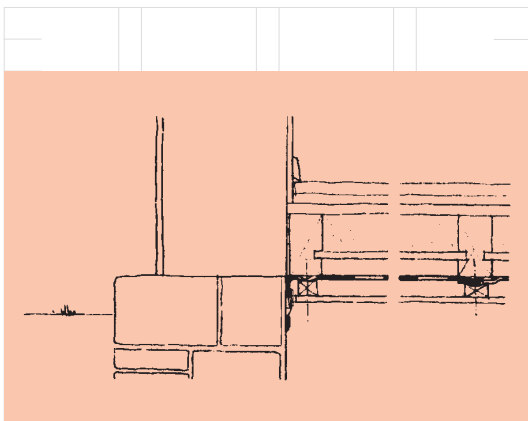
Raccordements d'une étanchéité sous plafond.
